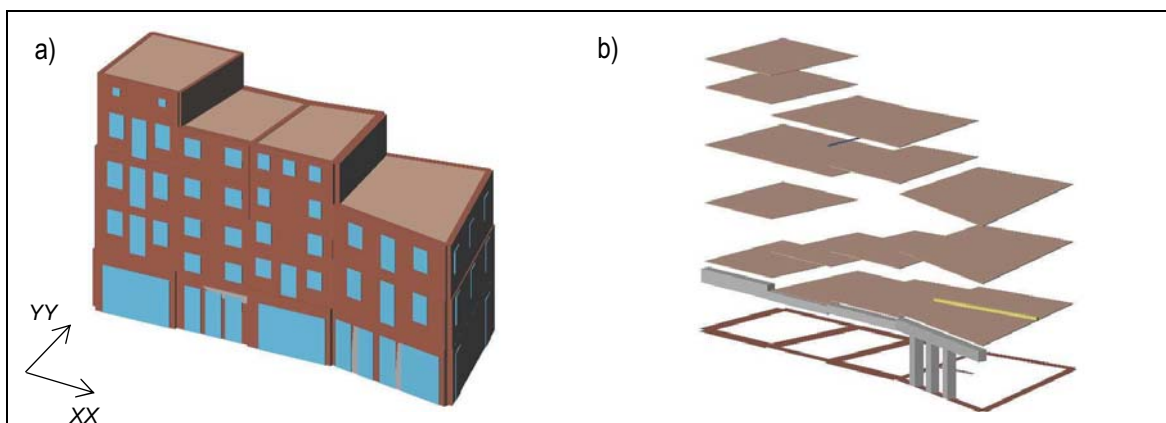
Modelo estrutural 3D desenvolvido: a) Modelo global; b) Pavimentos e elementos lineares (vigas, pilares e lintéis em betão armado)
